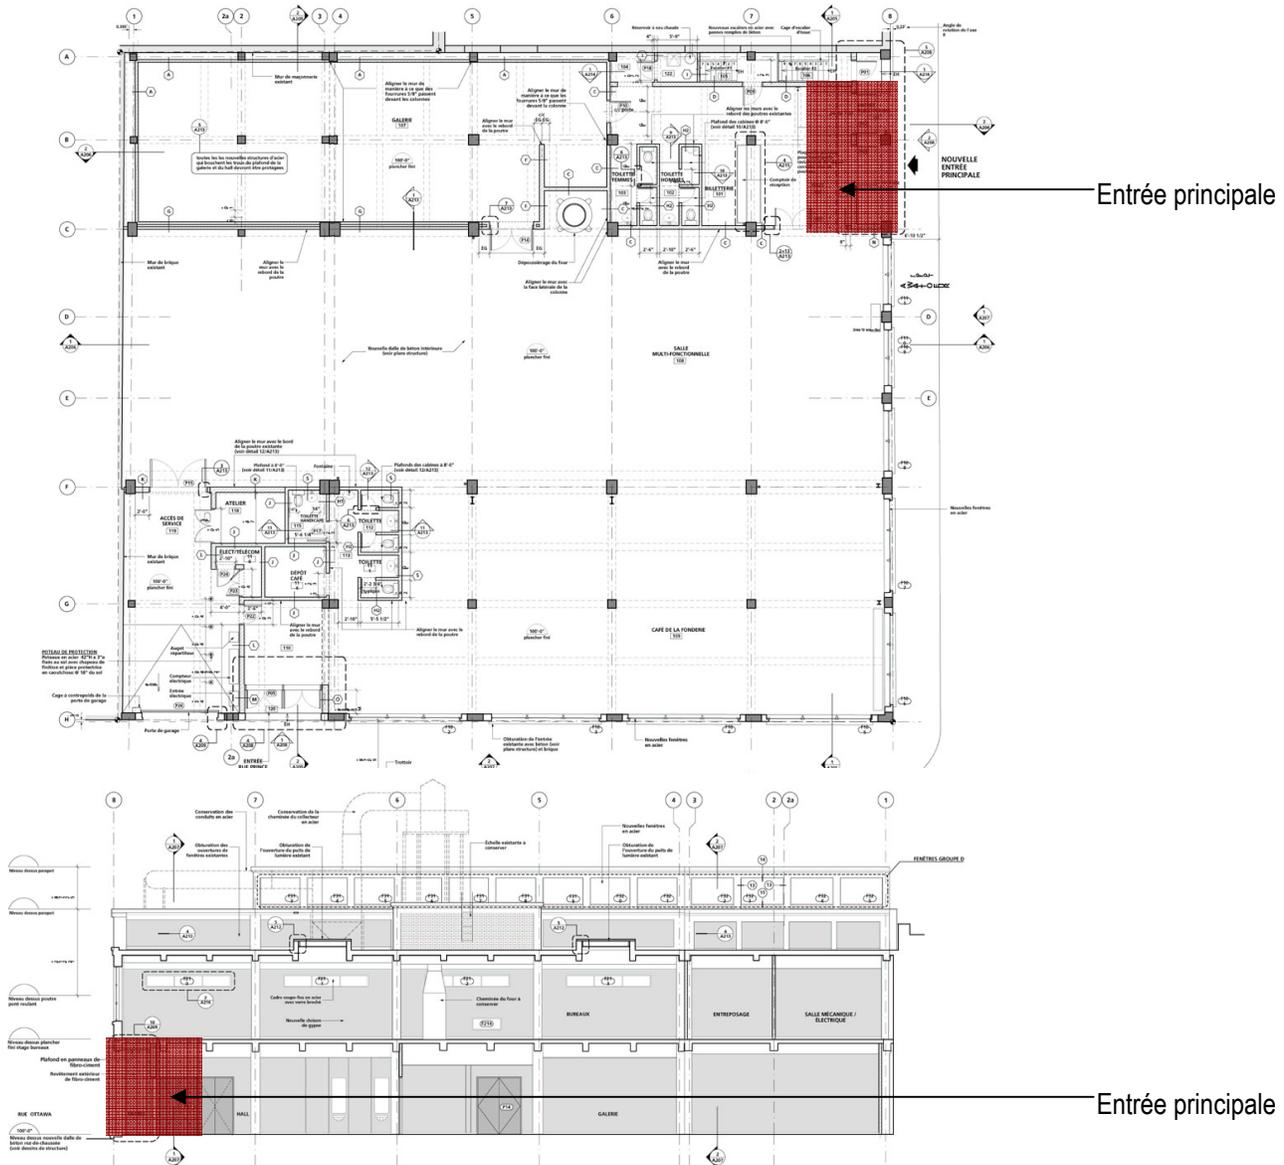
(A) Situation en plan et (B) en coupe du détail étudié (Source : Atelier in situ)
